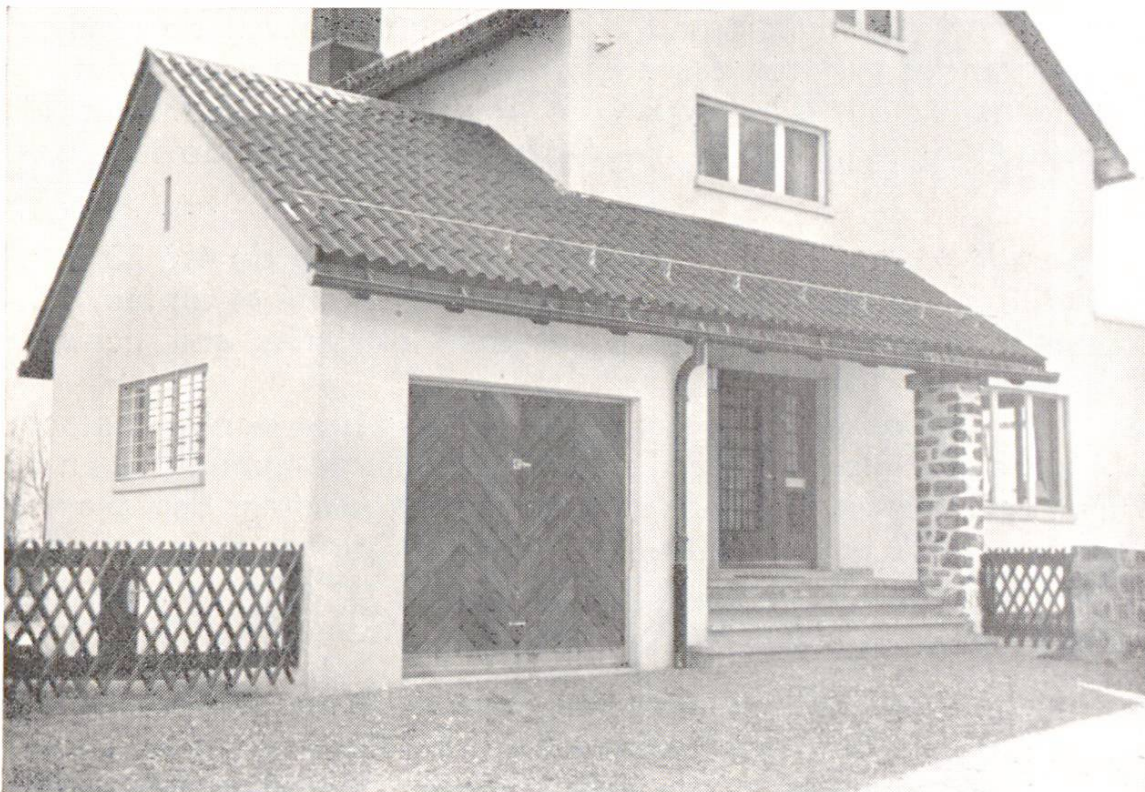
Toiture en dalles ondulées Eternit. Couleur brune-foncée, flammée.
